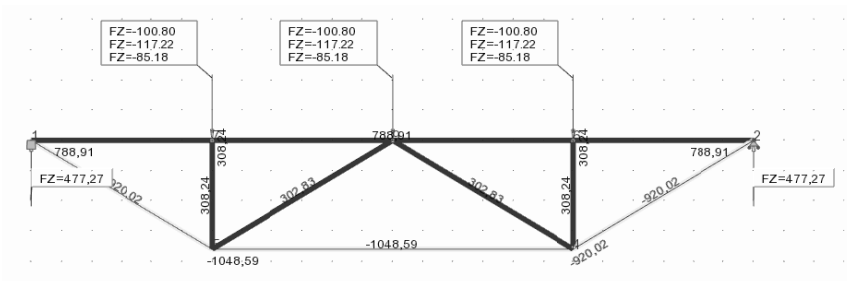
Пример расчета фермы: значения усилий в стержнях фермы при учете полных расчетных нагрузок (Robot Structural Analysis Professional)
